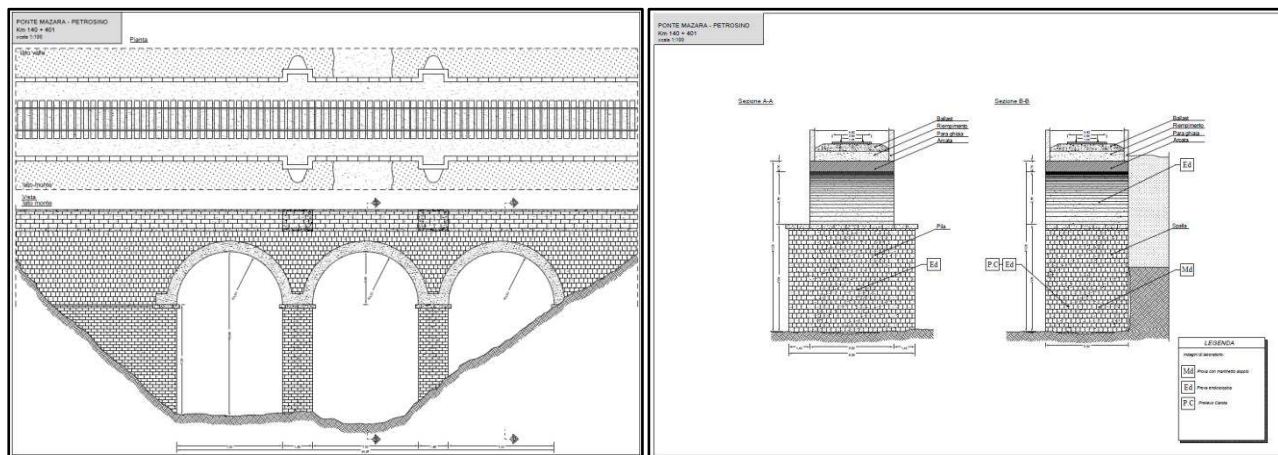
Pianta, prospetto e sezioni del manufatto.
